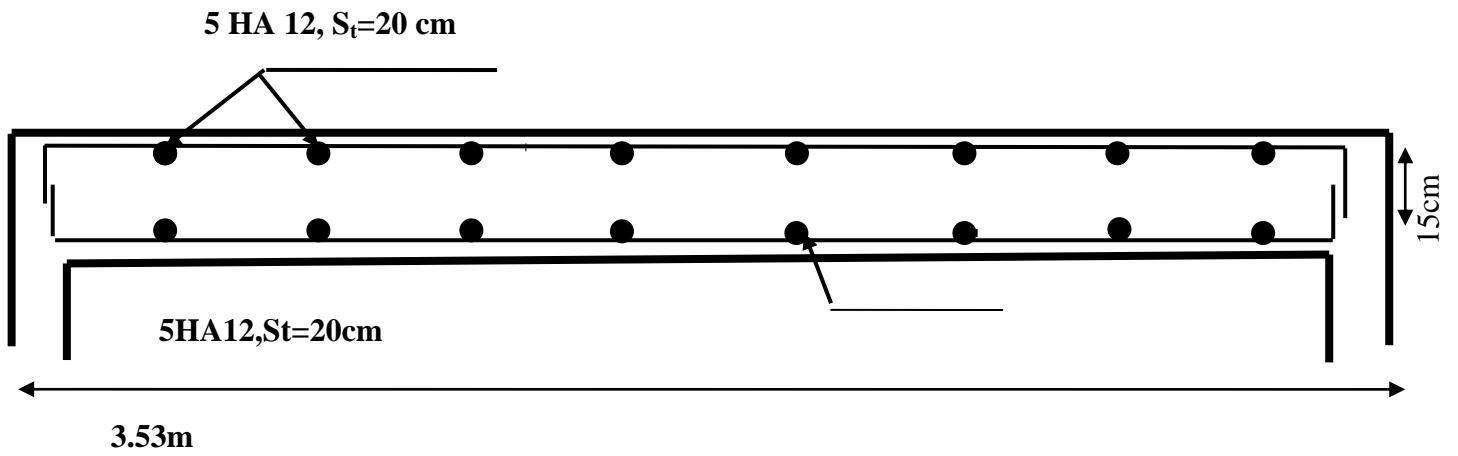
b : ferrailage de la salle machine suivant x-x.
